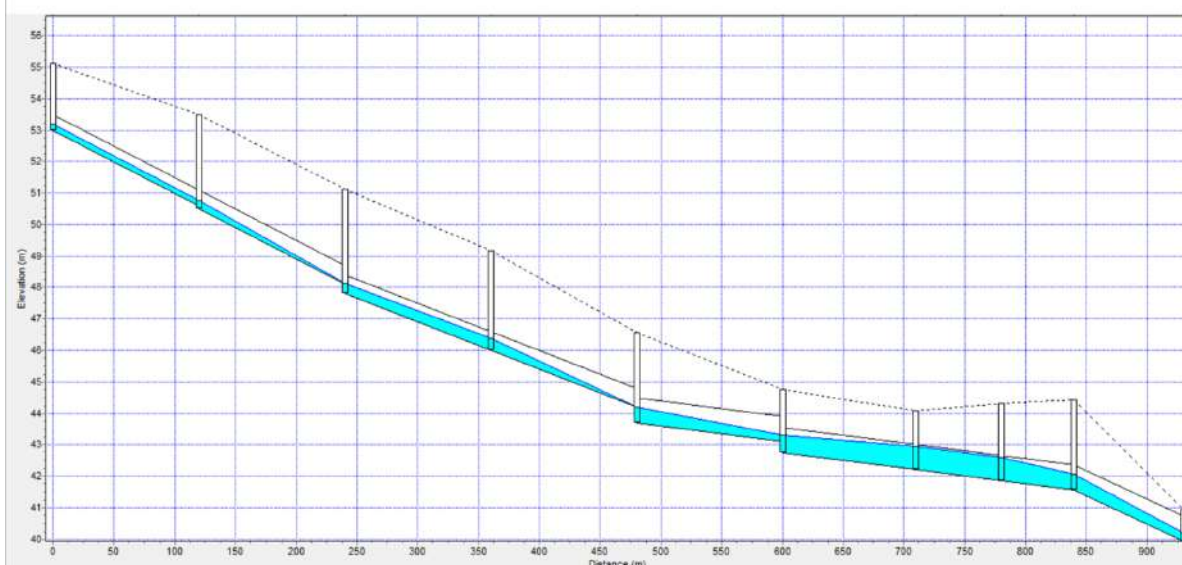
Perfil colectores calles Instrucciones del año XIII
